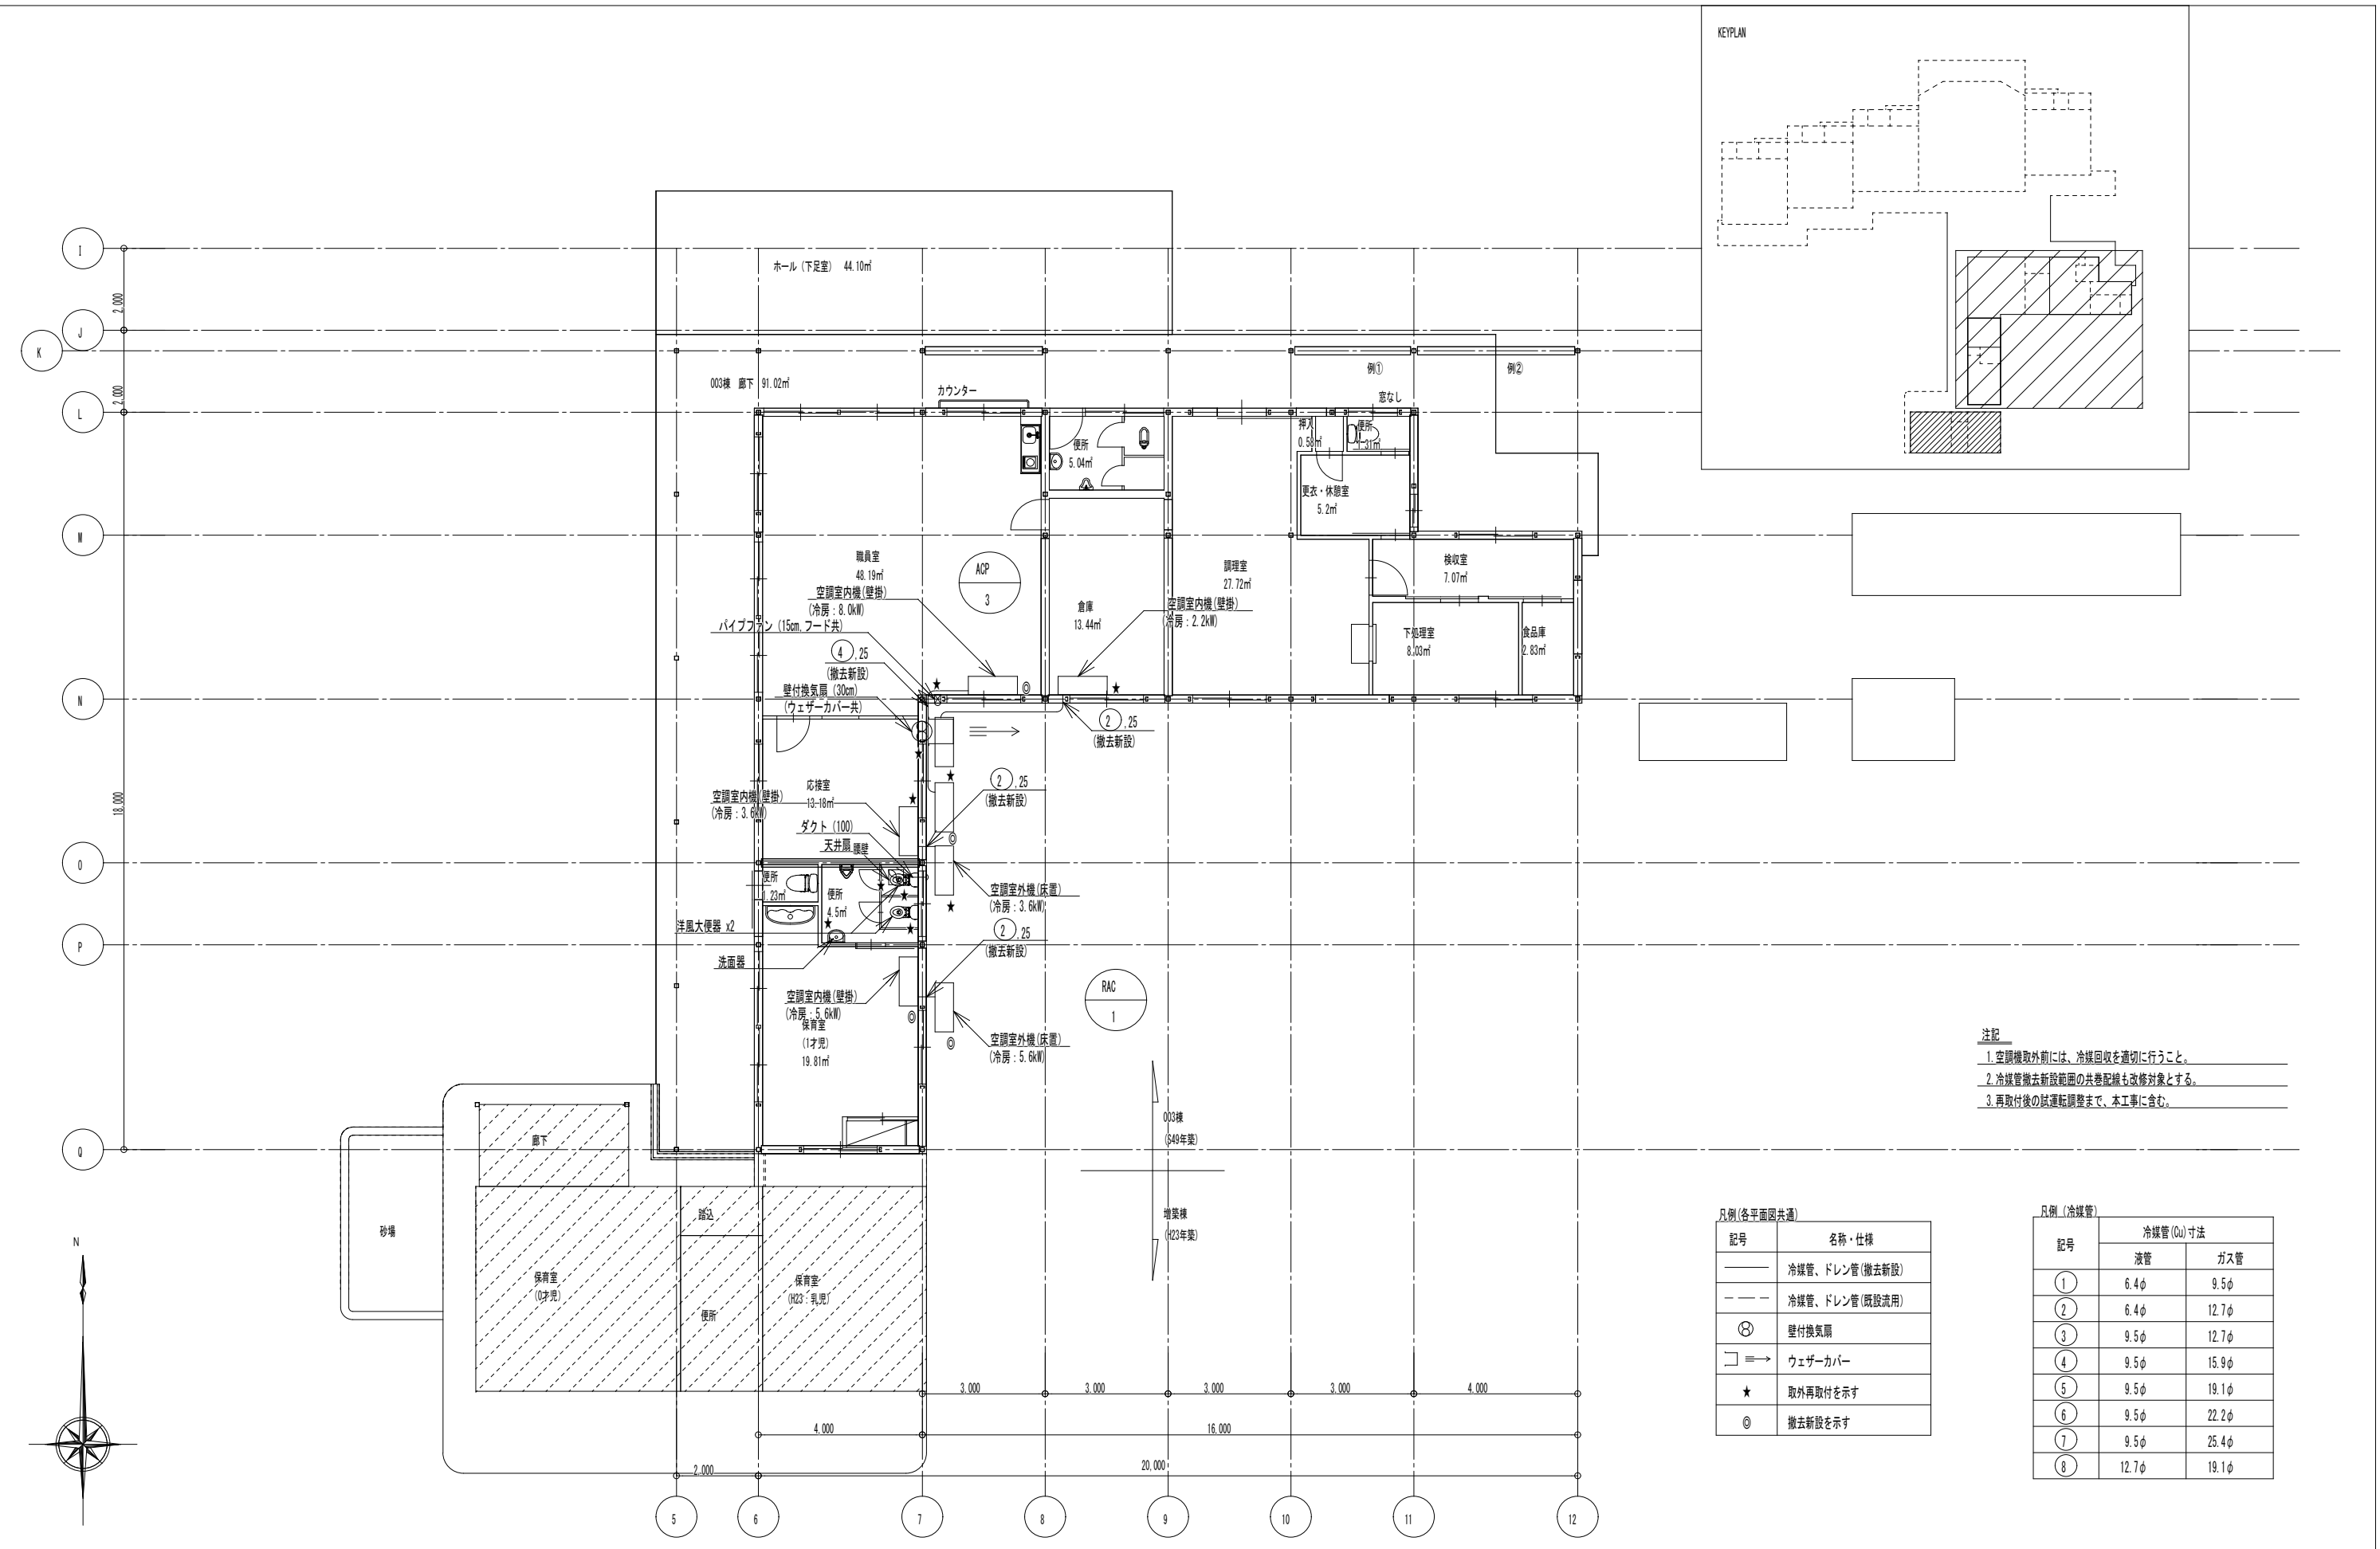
, 2棟 便所平面詳細図-3(撤去改修)
